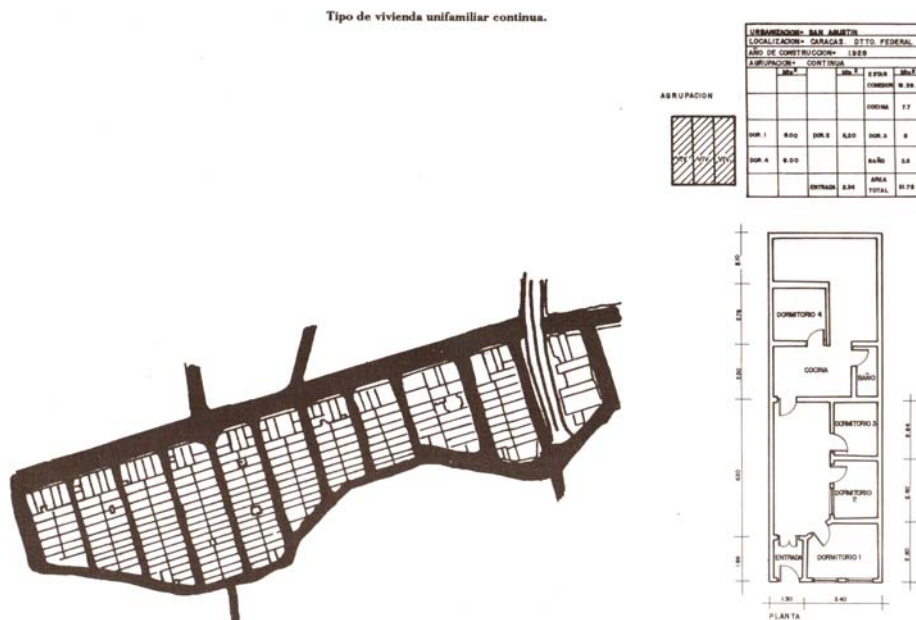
San Agustín del Sur, trazado y planta de vivienda.
